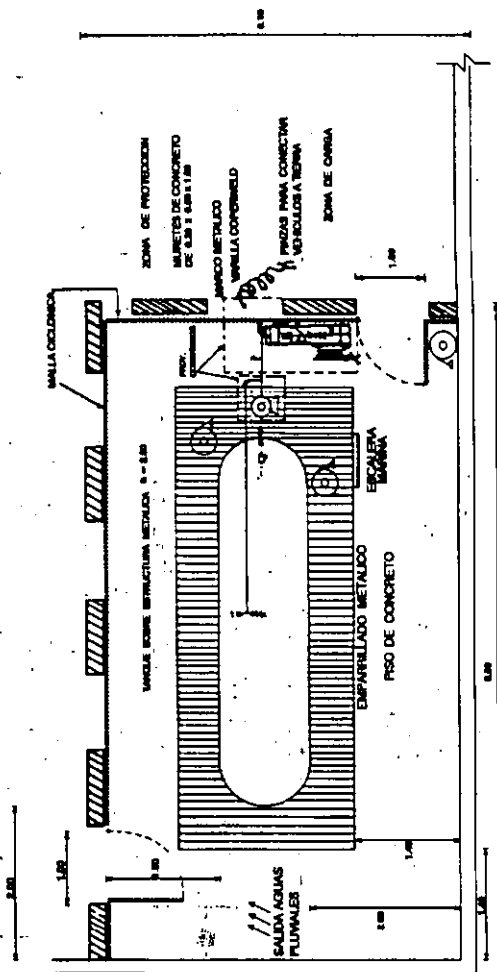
Planta de instalaciones donde se observan las características de la zona de protección
